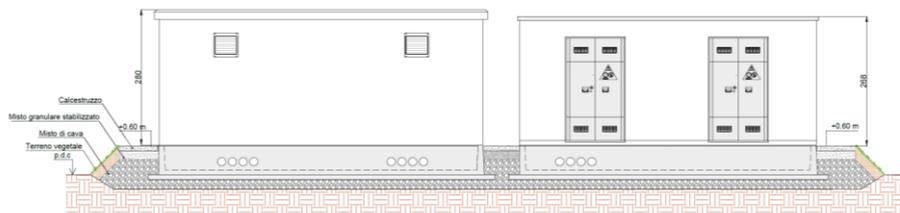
Planimetria e prospetto della Cabina di Trasformazione e Cabina inverter
